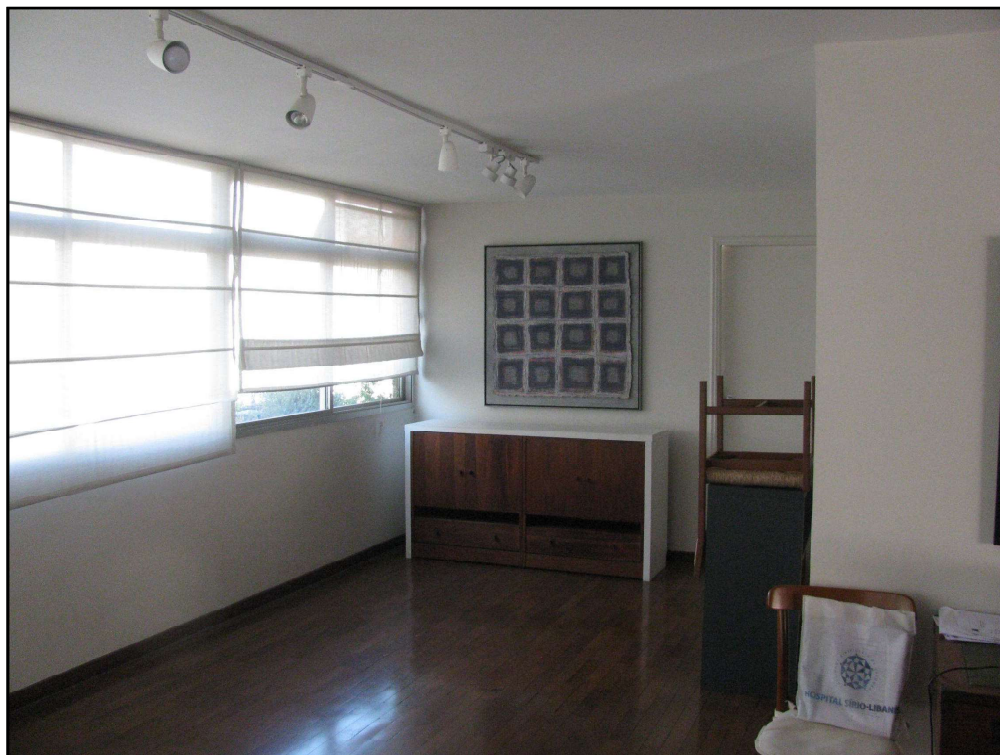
VISTA DA SALA DO APARTAMENTO Nº 6.
